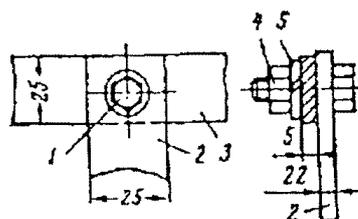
Присоединение заземляющего проводника из полосовой стали к магистрали: 1 - болт; 2 - проводник; 3 - магистраль; 4 - гайка; 5 - шайба
